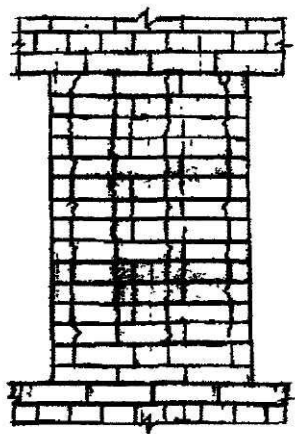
Схема третьей стадии напряженно деформированного состояния каменной кладки.
